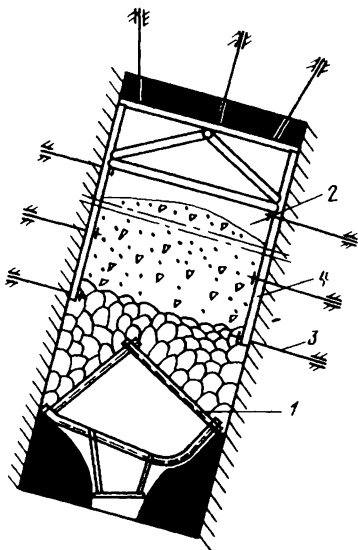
Схема крепления расчески при отработке пласта с применением щитового перекрытия и закладки выработанного пространства
